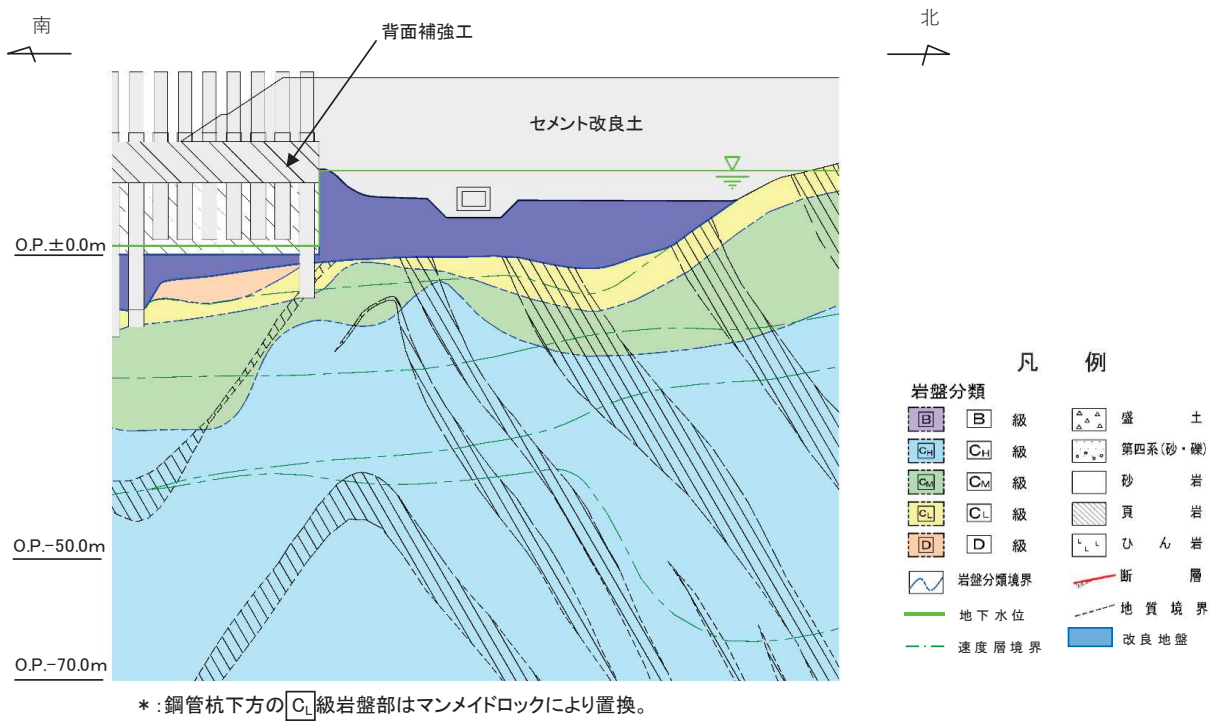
北側排水路の評価対象断面図 (A-A 断面)
